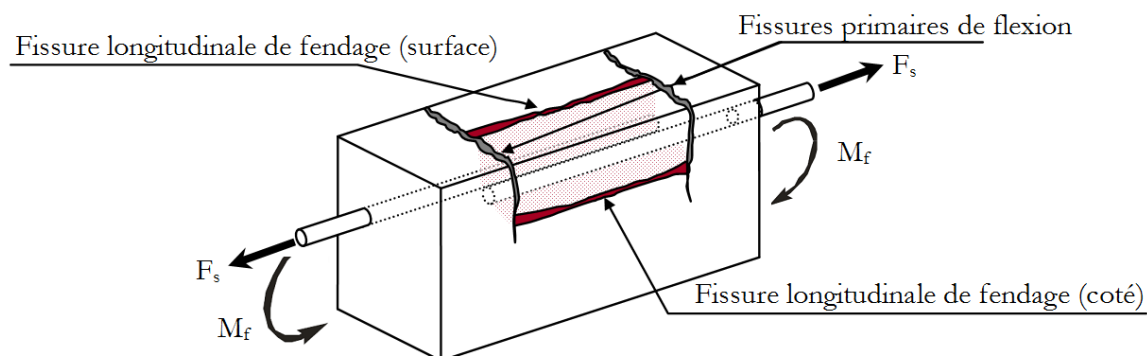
Fissures primaires de flexion et fissures longitudinales de fendage en zone de chevauchement
